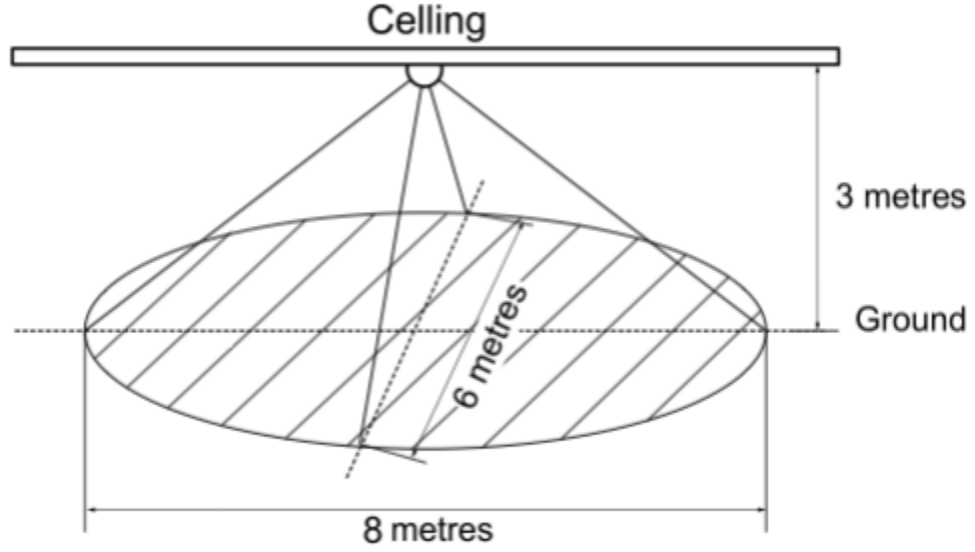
Installation du capteur de mouvement au plafond : (source manuel officiel)
